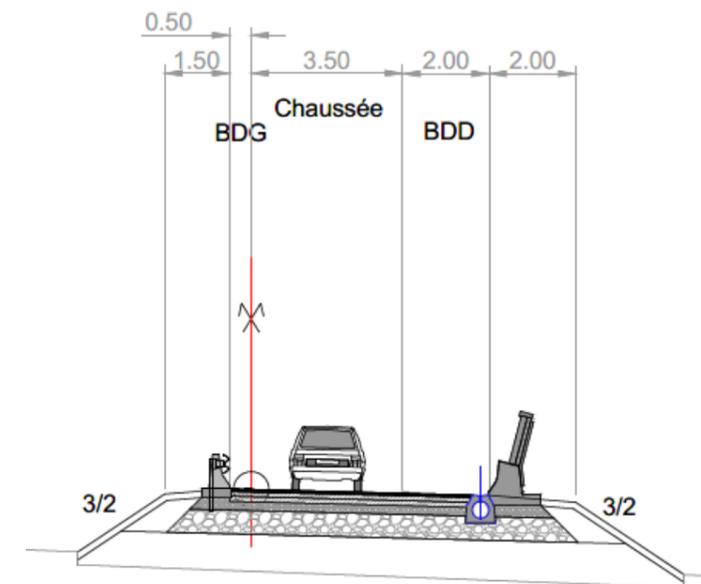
Profil en travers type d'une bretelle unidirectionnelle avec écran acoustique (bretelles de l'échangeur M952)
